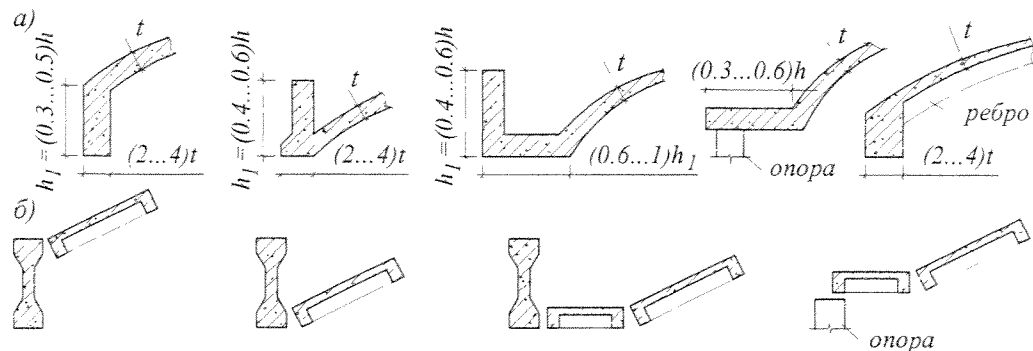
Типы бортовых элементов железобетонных оболочек:
